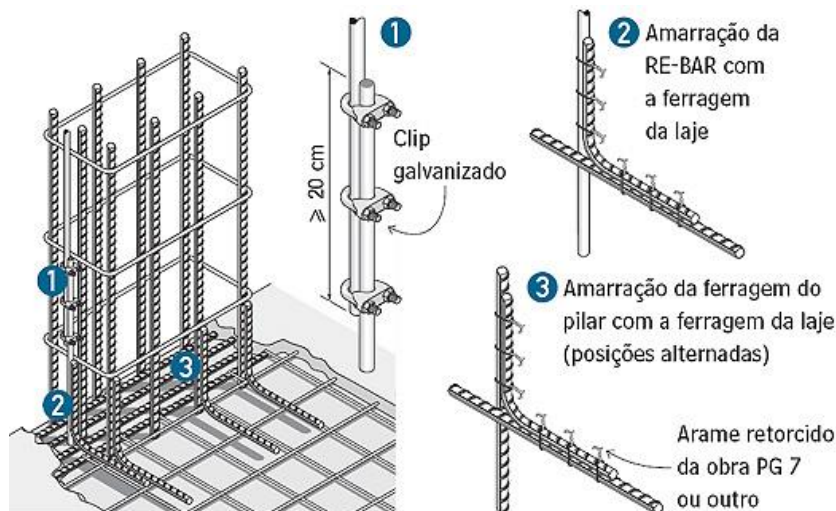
Detalhe da barras de aço galvanizadas a fogo anexada as armaduras
